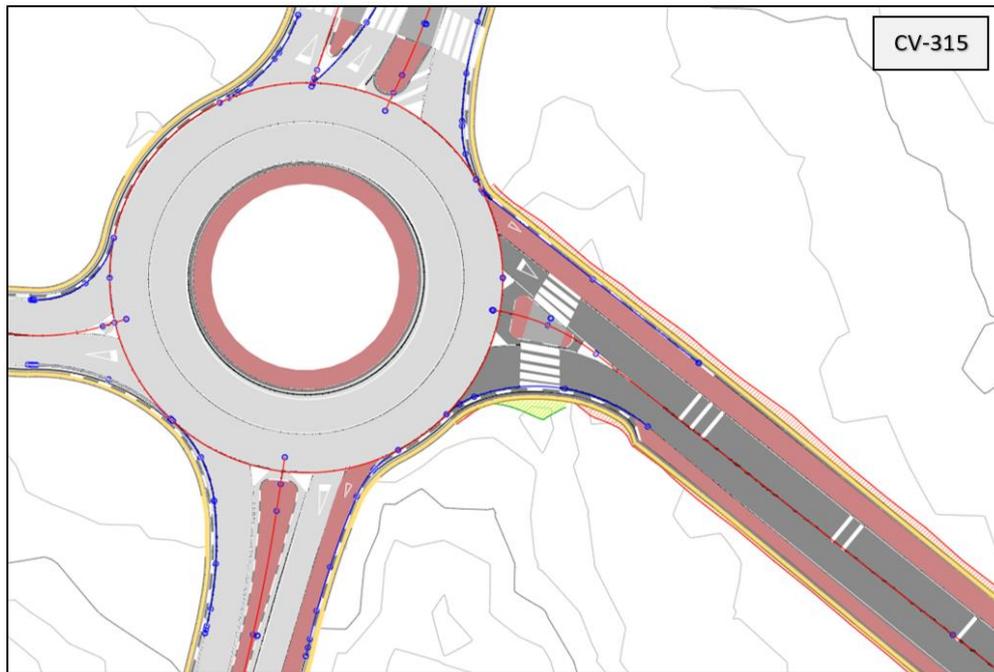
Detalle glorieta - Situación actual CV-315 (Acceso este)
